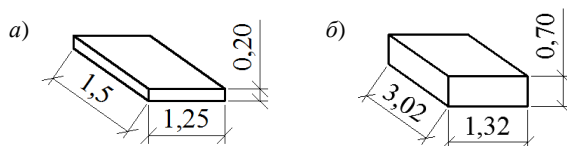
Общий вид фундаментных плит (а) и блоков (б)
